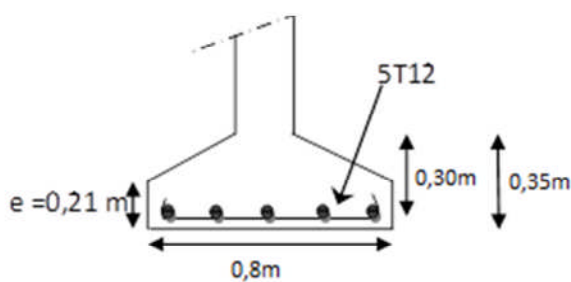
Ferrailage de la semelle central et intermédiaire
